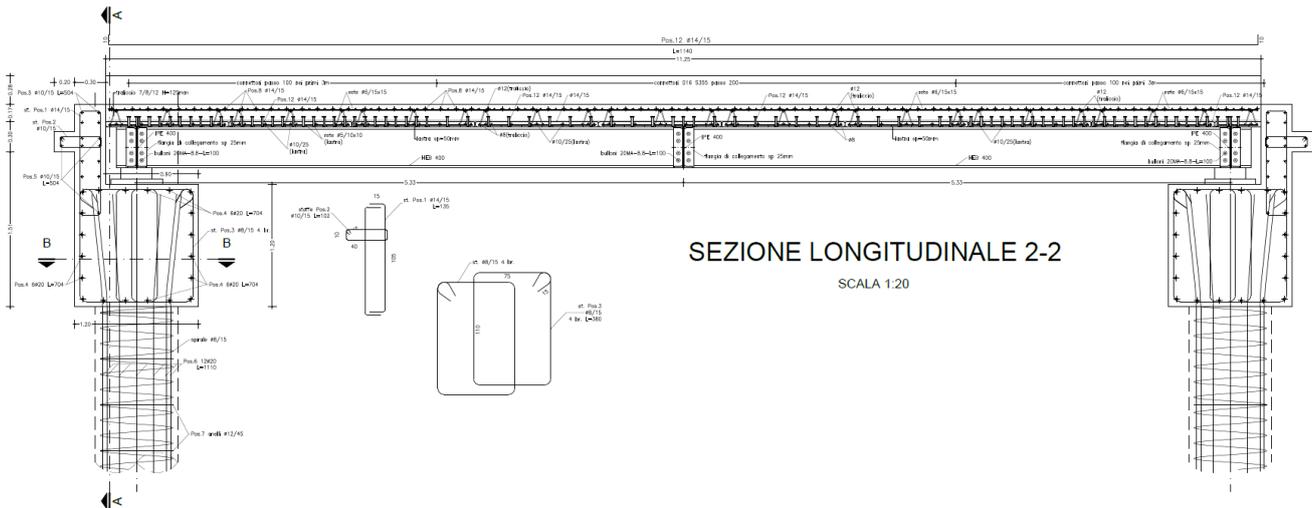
sezione longitudinale del nuovo ponte sul canale fuggatore.
